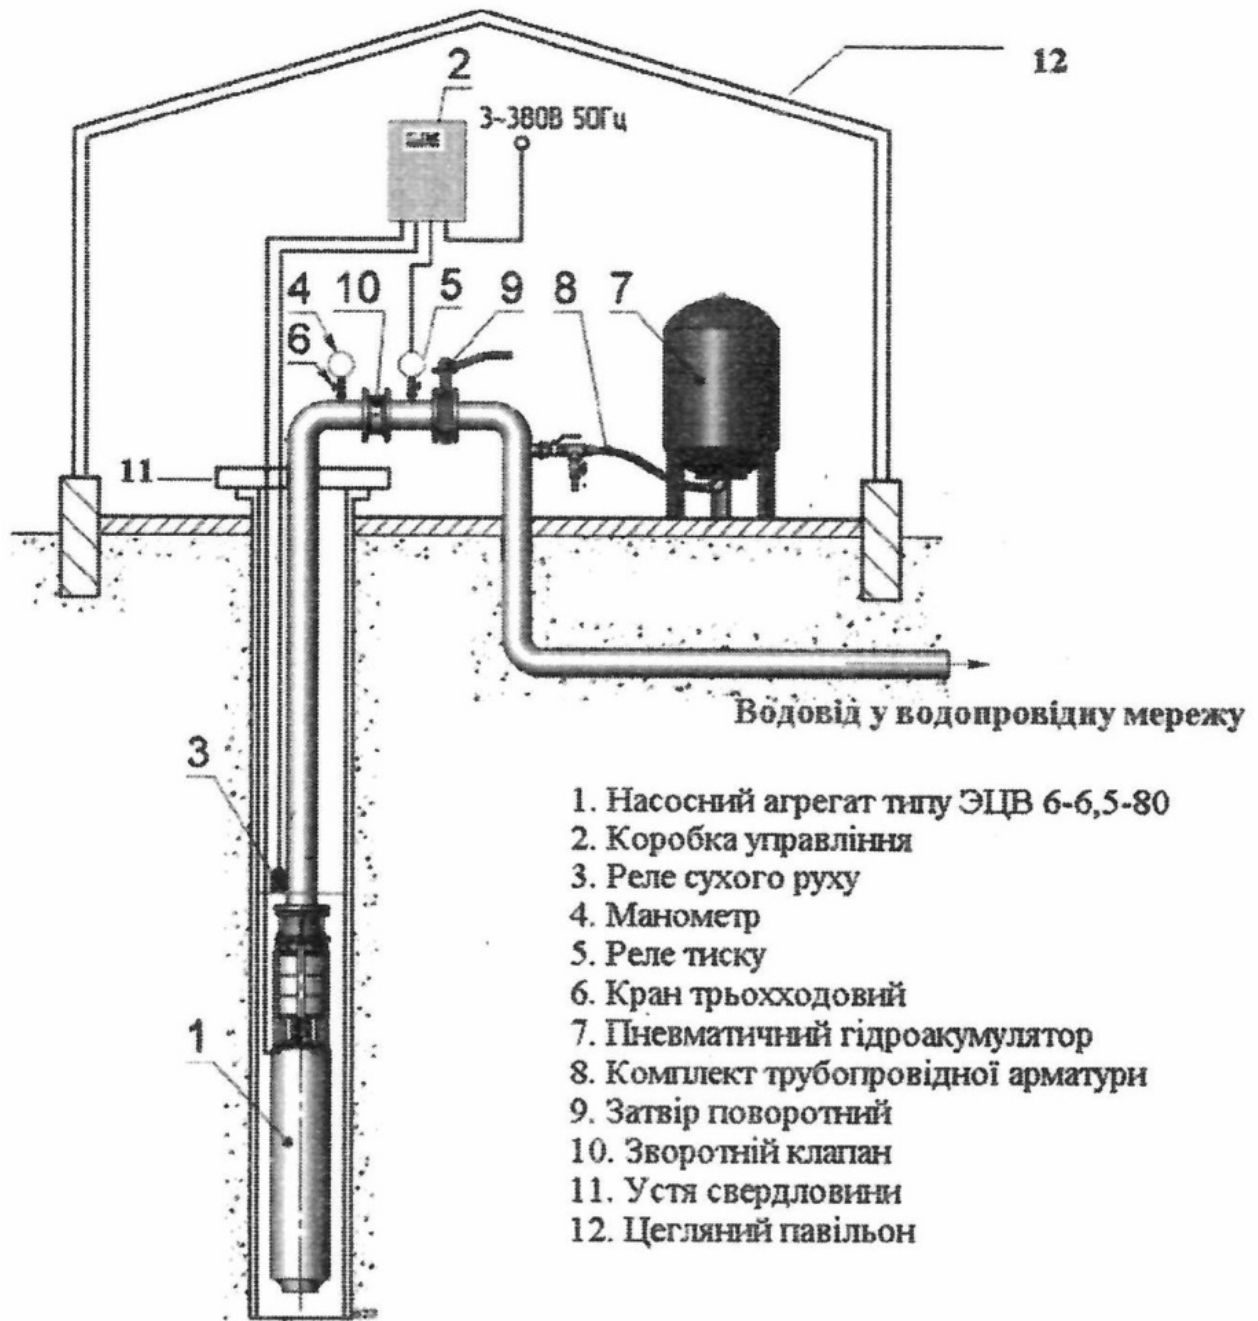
Конструкція свердловини № 1 (405)
